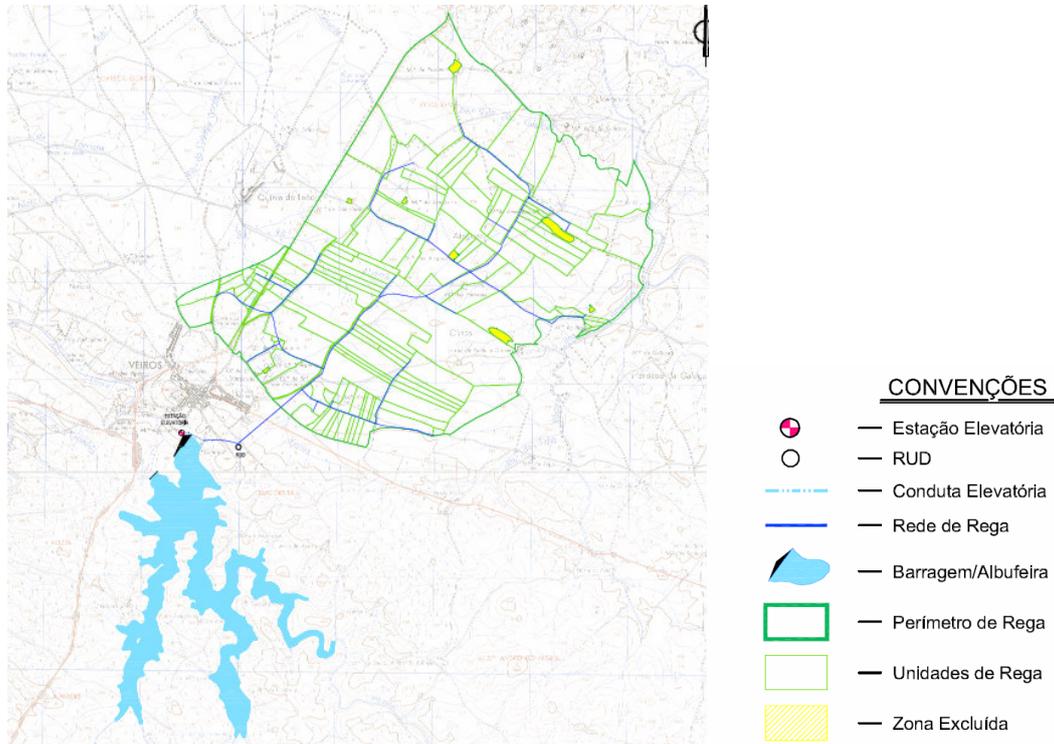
Aproveitamento Hidroagrícola de Veiros Rede de Rega – Planta de Localização
